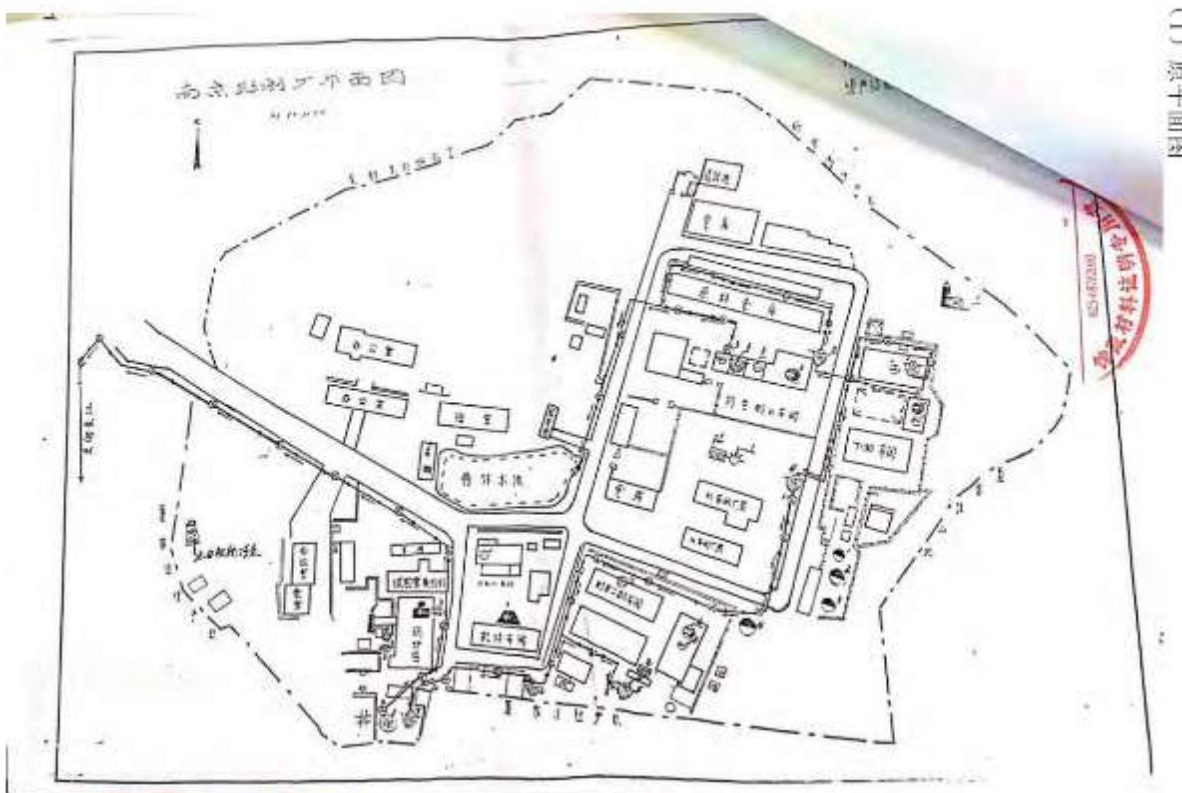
原南京助剂厂平面图 (含污水管走向-附件五)
